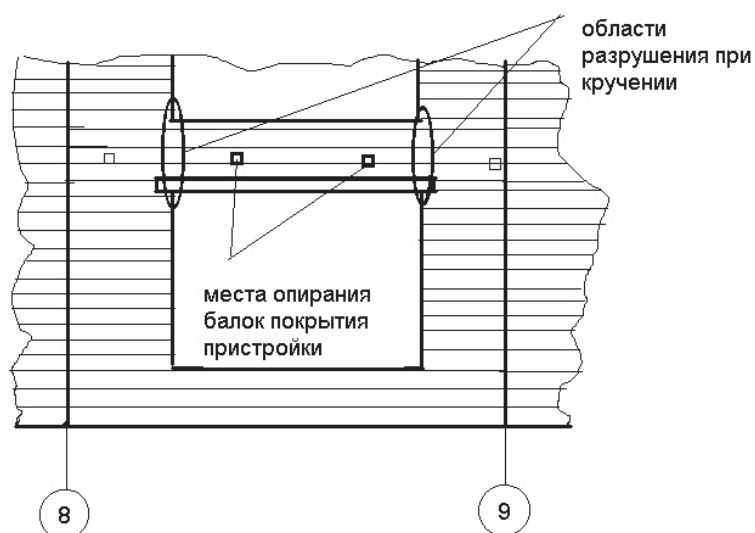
Места опирания балок покрытия и зоны разрушения кладки при кручении
